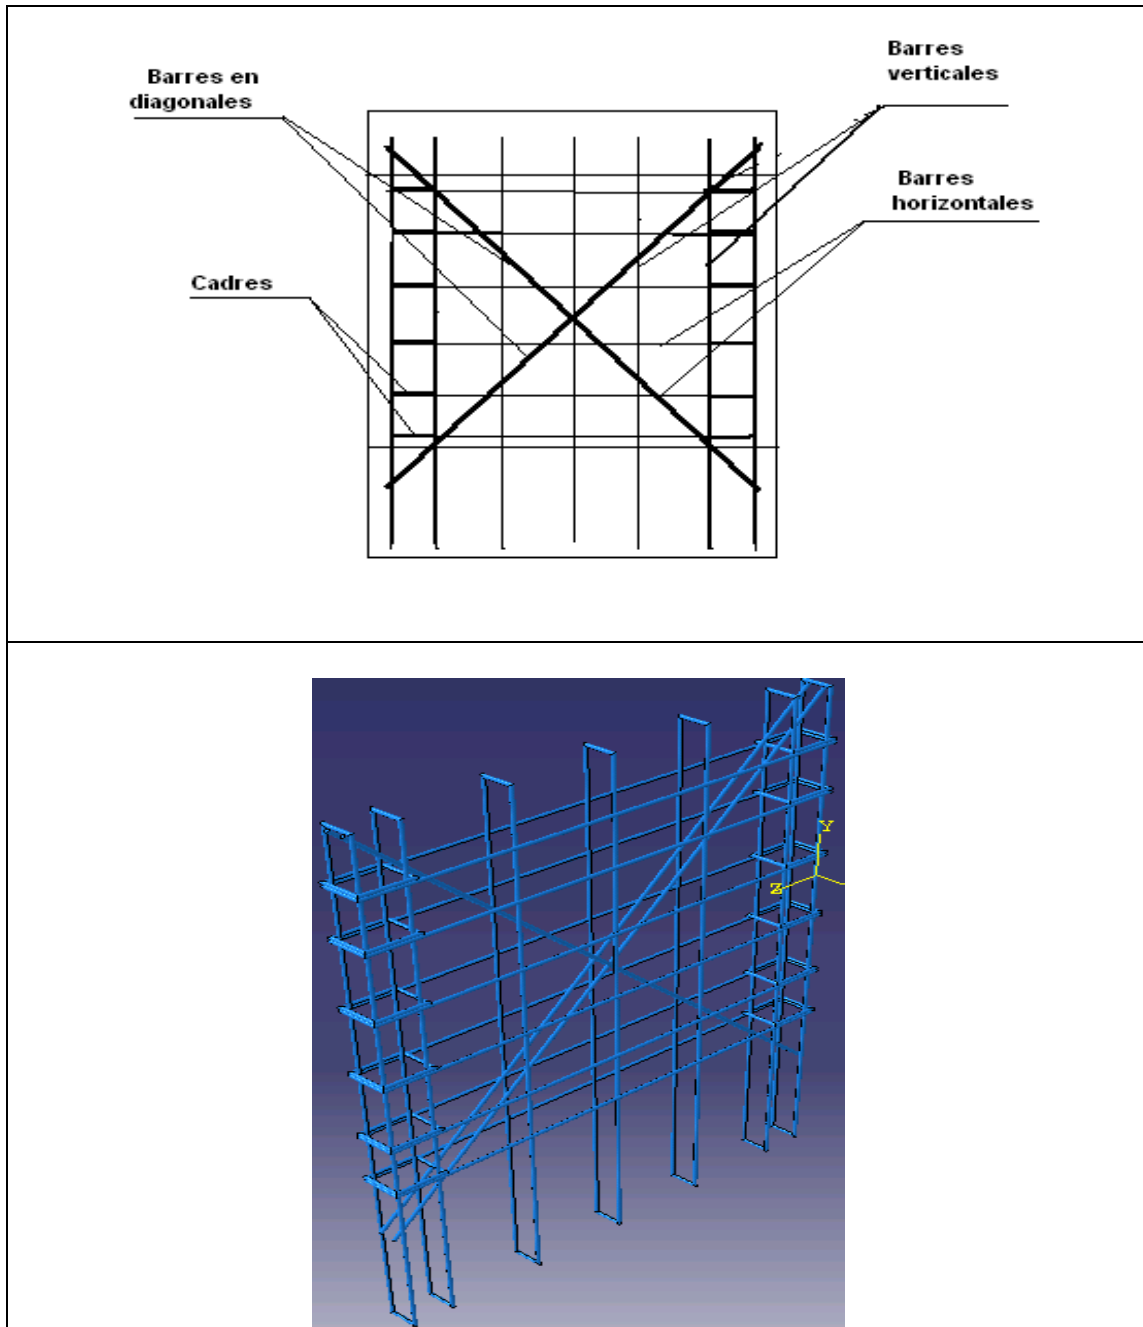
Ferrailage voile renforcé à 4 barres.
